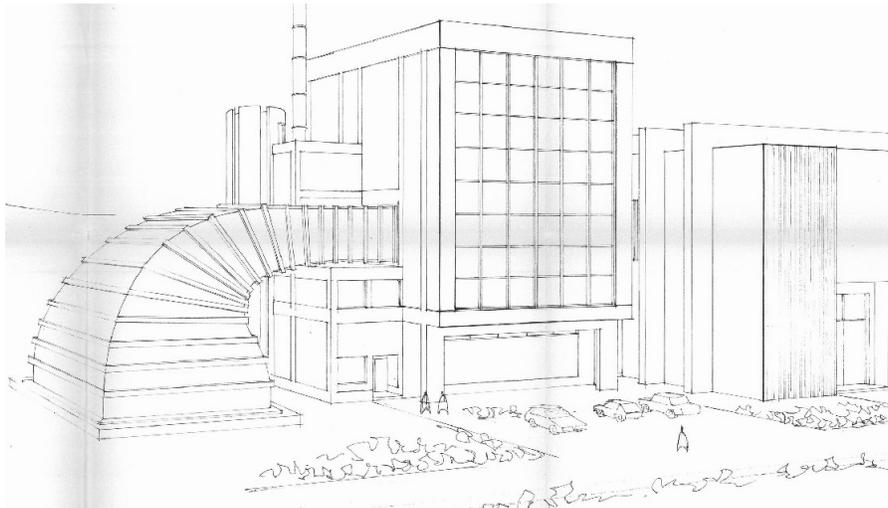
disegno tridimensionale della parte esterna del manufatto (canale di circolazione) oggetto degli interventi di manutenzione – Cornue in acciaio (sulla parte sinistra dell'immagine)
